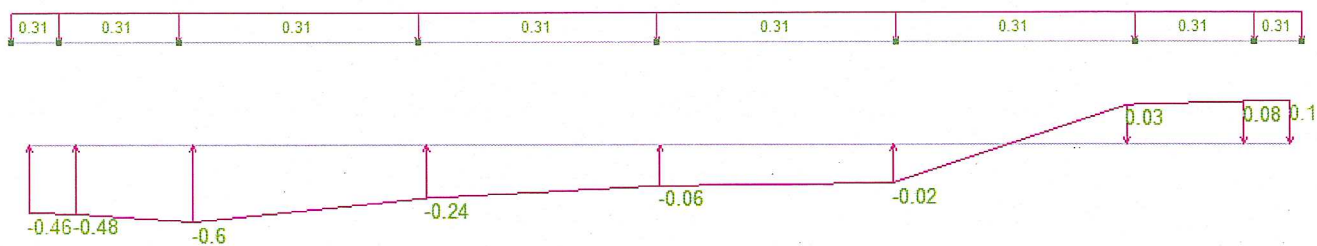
Схема приложения нагрузка на балку: а – нагрузка от собственного веса кровли, б – ветровая нагрузка
